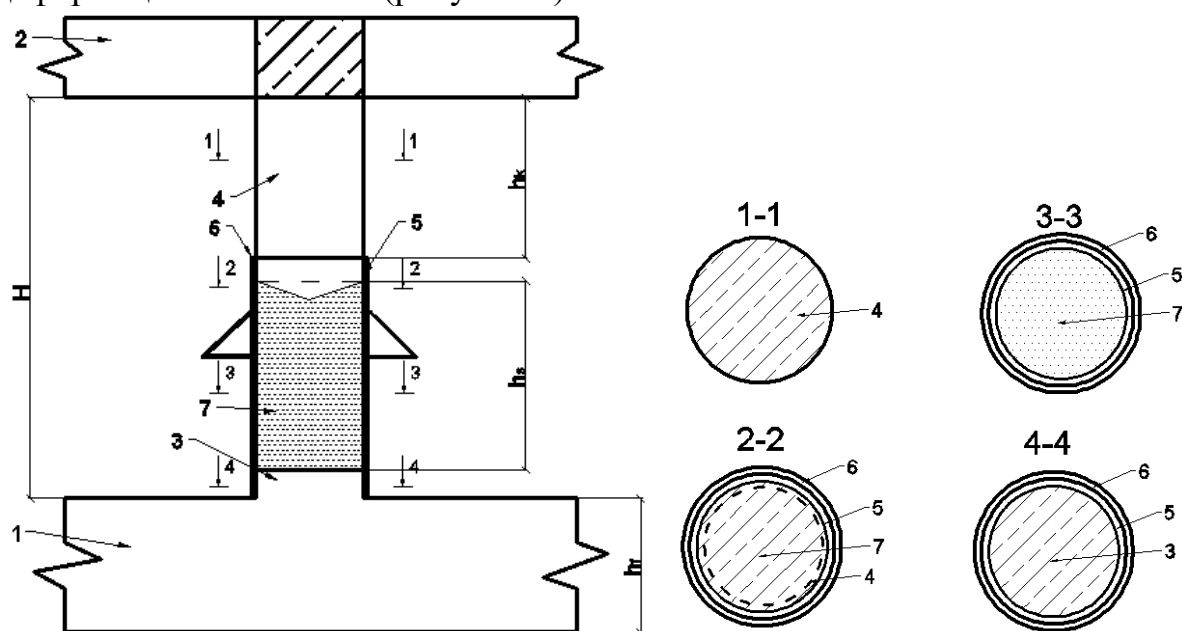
Схема фундамента с устройством для исправления кренов сооружений: 1 – фундаментная плита; 2 – система перекрестных балок – стенок; 3 – цилиндрический выступ из фундаментной плиты; 4 – цилиндрический элемент из труботетона, заделанный в перекрестную систему балок – стенок; 5 – внутренняя труба устройства; 6 – наружная труба устройства; 7 – рабочее тело (песок); Н – высота технического подполья; h_s – высота рабочего тела в устройстве; h_k – зазор между устройством и низом системы перекрестных балок.
